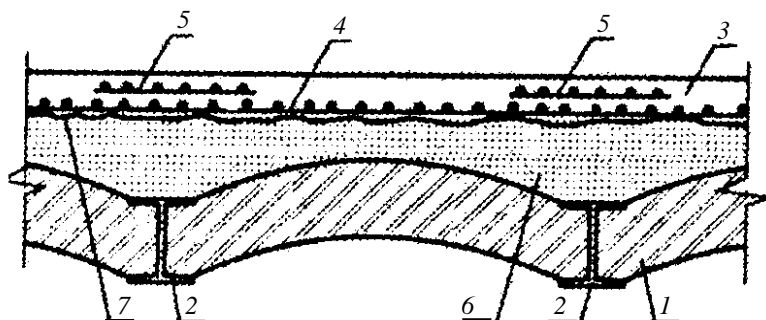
Устройство железобетонного наращивания в виде плиты сверху:
